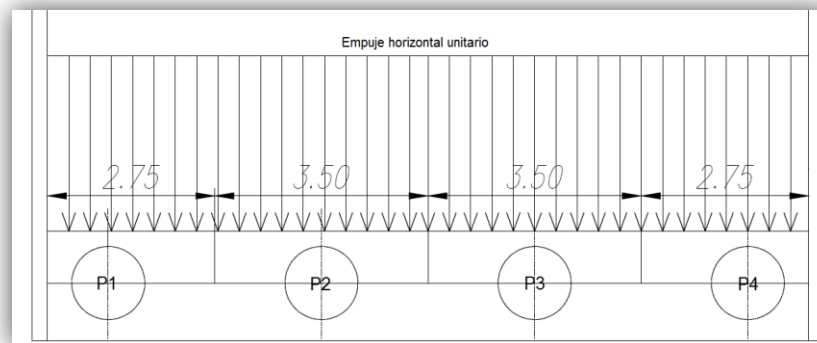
Empuje lateral de suelo sobre estribo y columnas - pilotes
